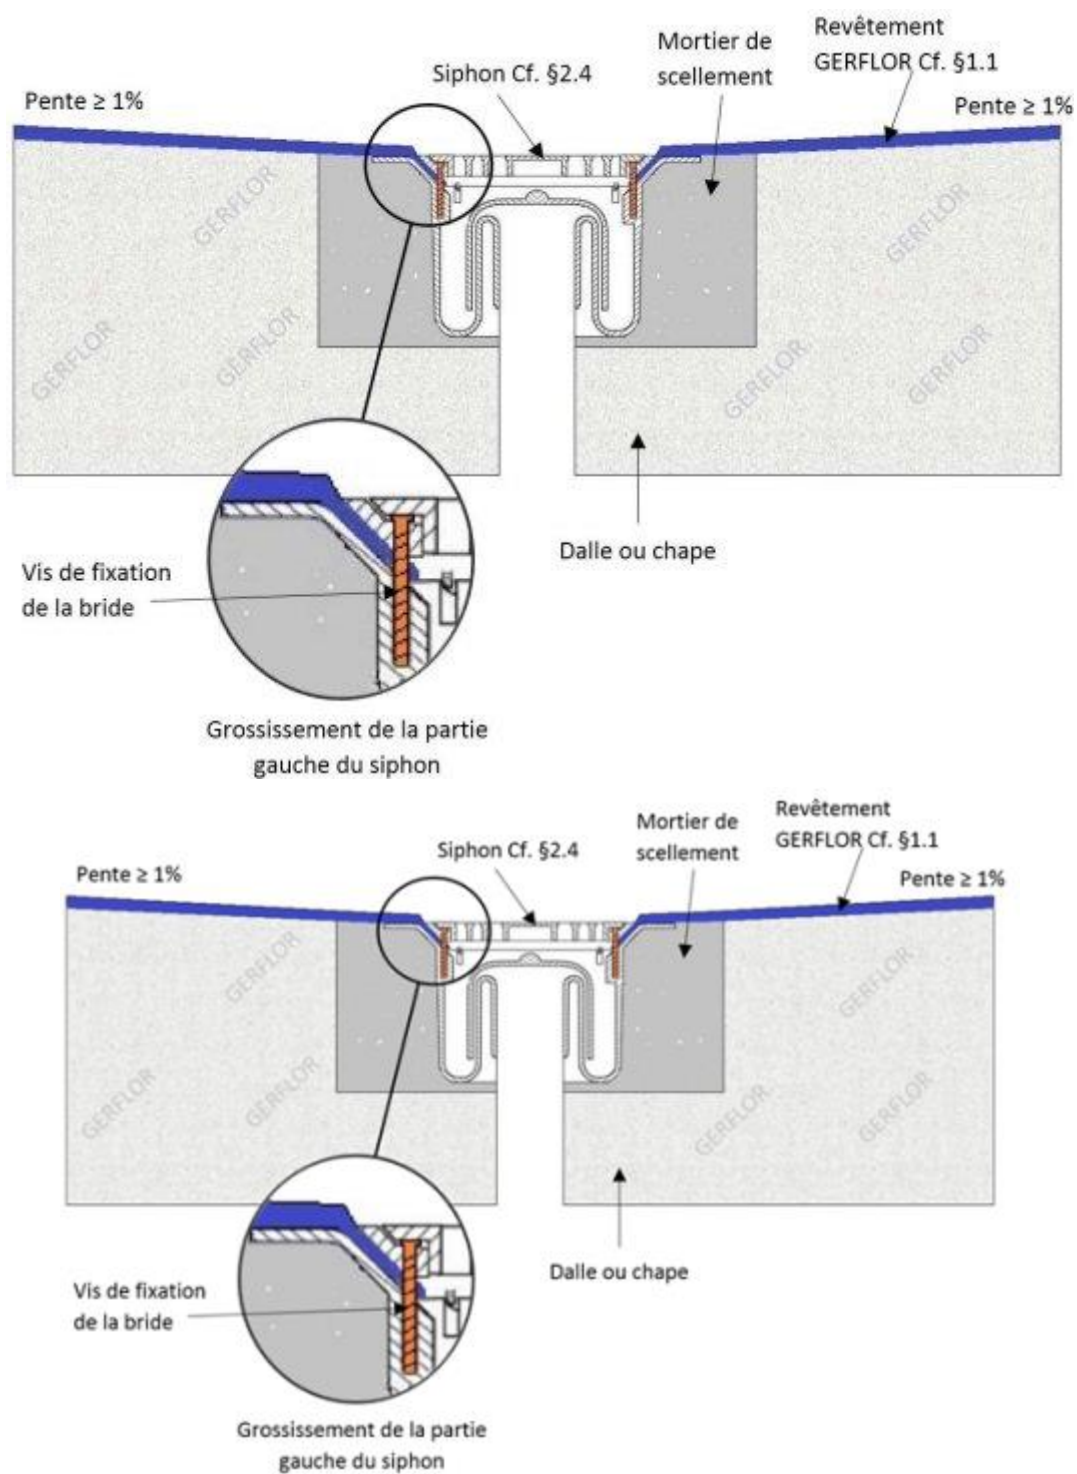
Exemple de traitement de raccordement au siphon sur chape ou dalle adhérente à base de liants hydrauliques
